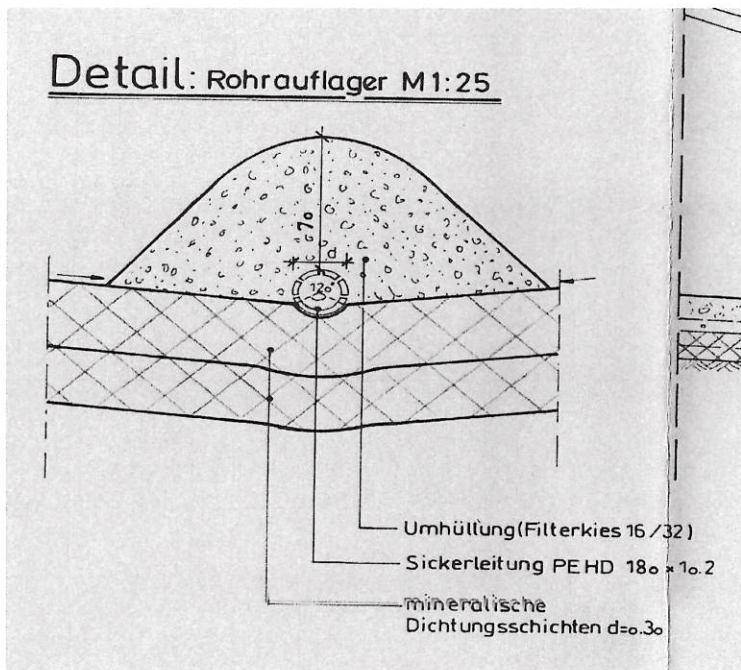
Einbau Da 180 Rohre gemäß 1.5
